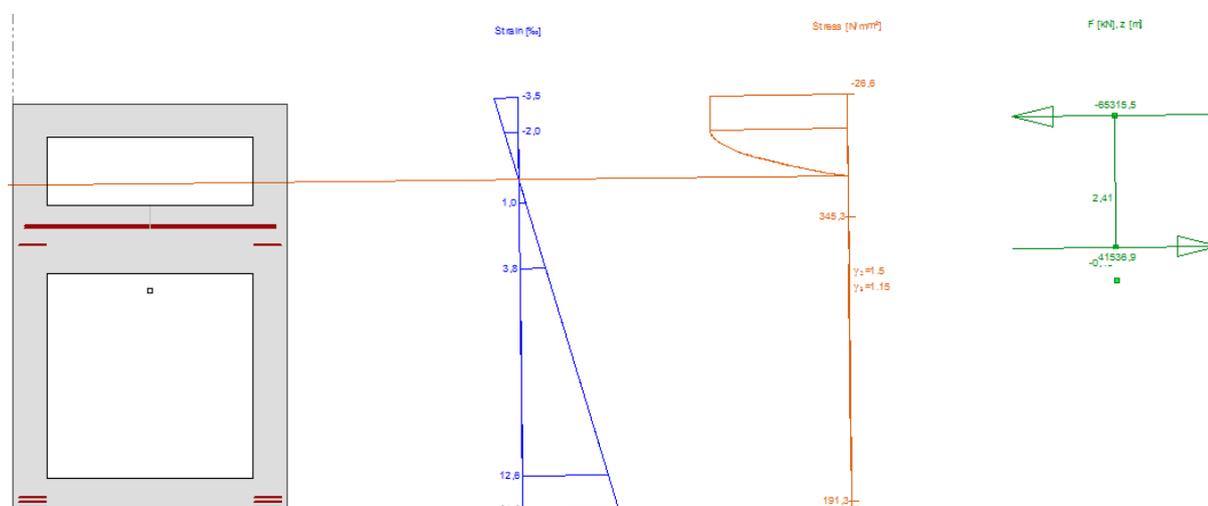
Dimensionamento da secção de coroamento das pilastras em Estado Limite Último de flexão (*Fagus-4*)
